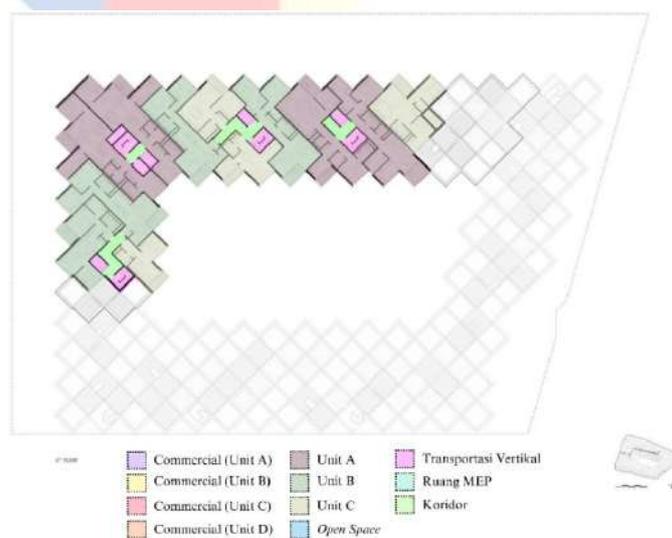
Denah 3rd Floor 79 & Park Residences
